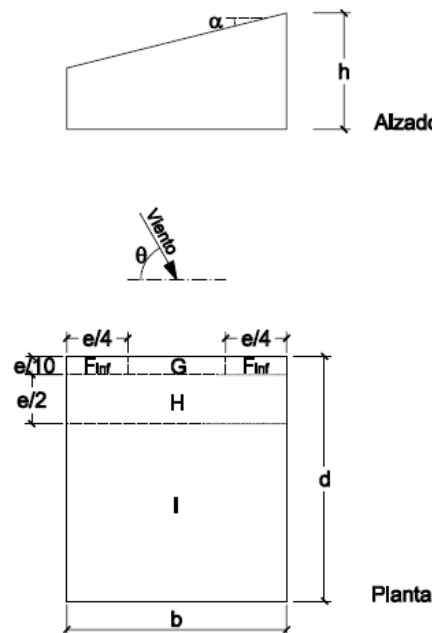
Zonas de la cubierta de la nave adosada para viento longitudinal.
